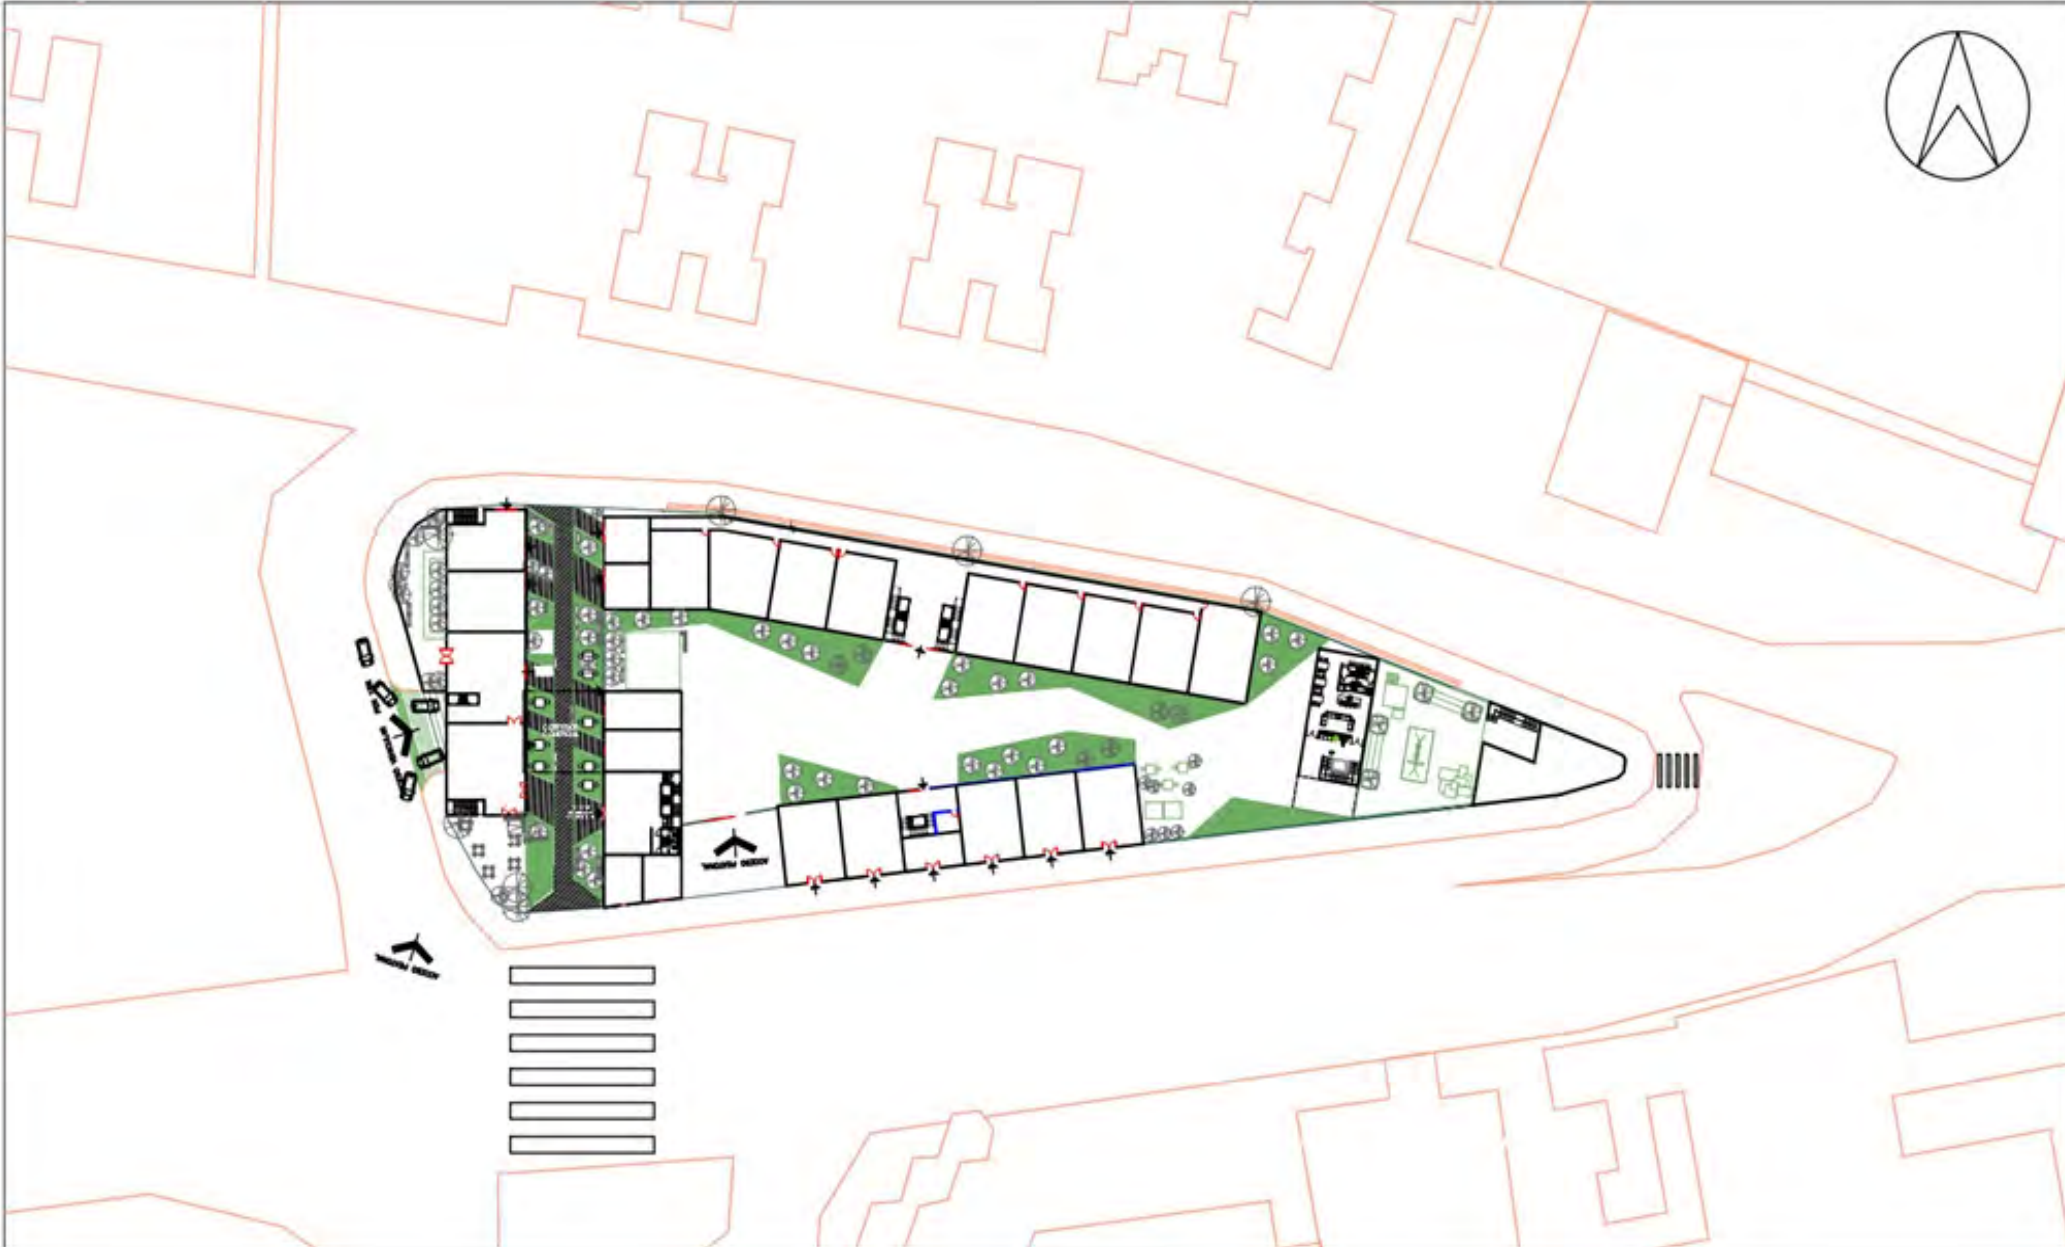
Planta Baja de conjunto, entrega final de 9° semestre. creación de Diana Gómez y creación propia
